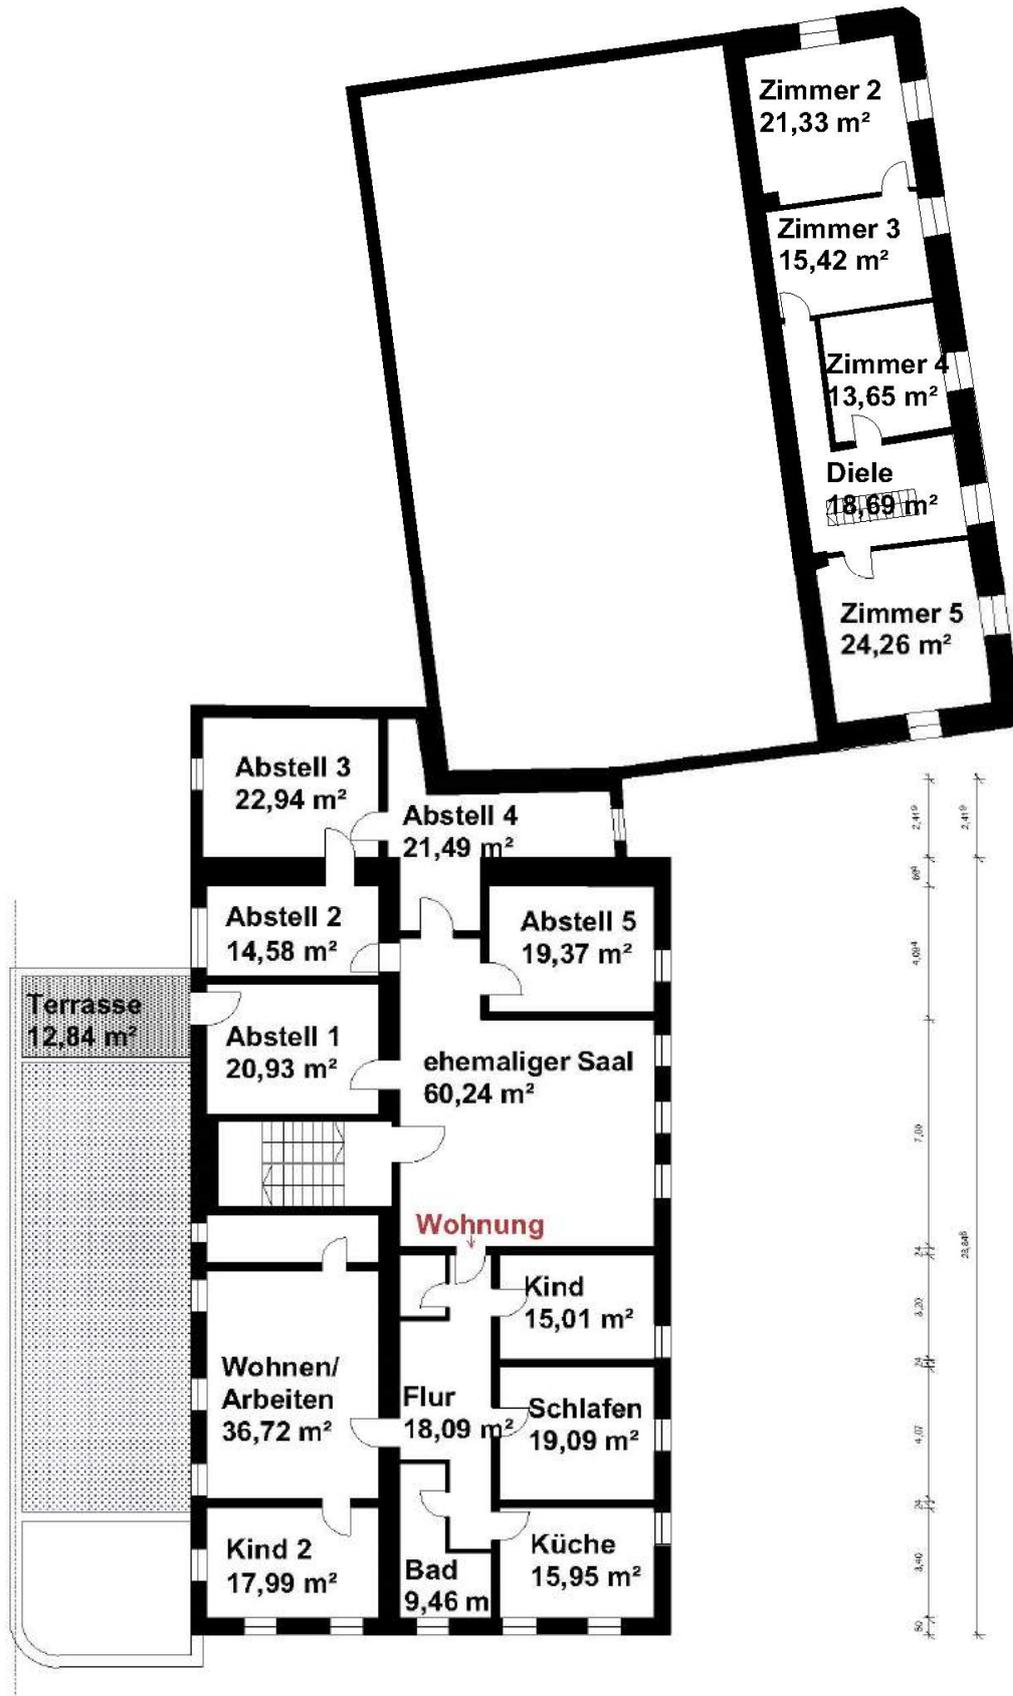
Gasthaus Dollmaier – Obergeschoß Bestand
